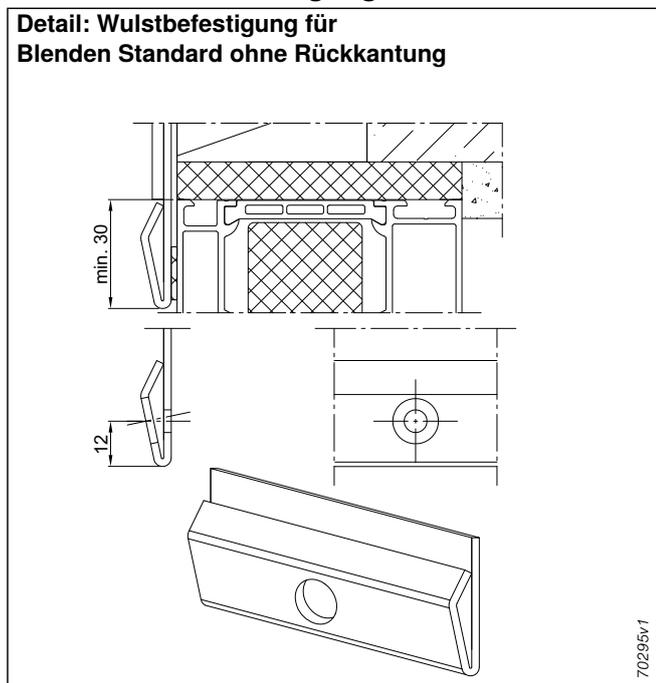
Wulstbefestigung für Blenden ohne Rückkantung
